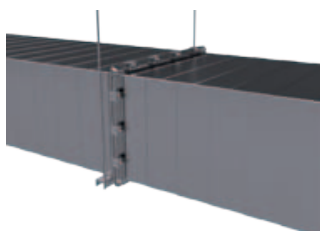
Rohové styky desek jsou spojeny požárními vrtů Fire Screw.
